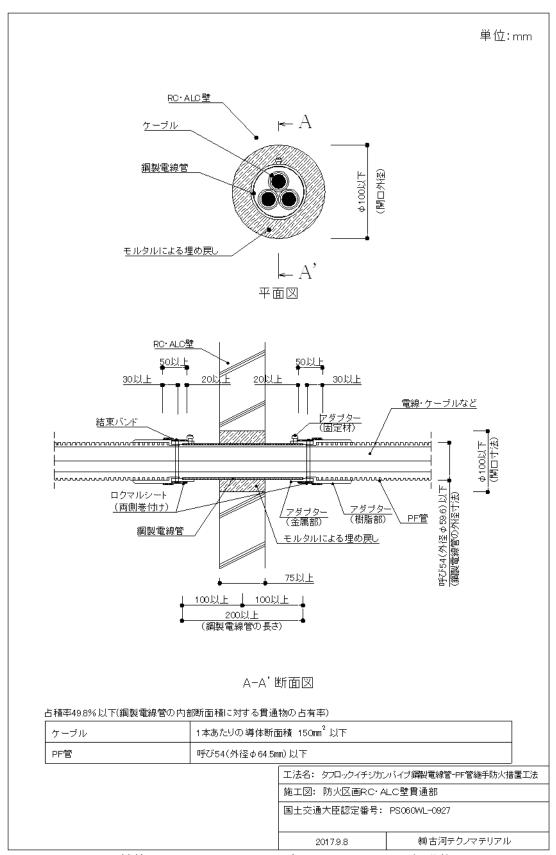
鉄筋コンクリート(RC)·ALC 壁(PS060WL-0927) 標準施工図
